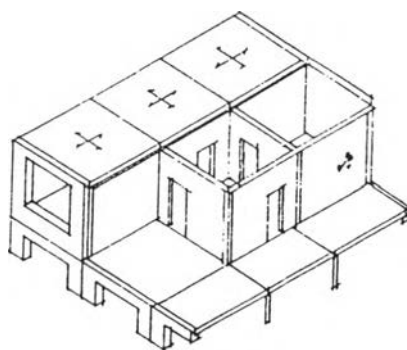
แสดงระบบโครงสร้างแบบ Long Wall
